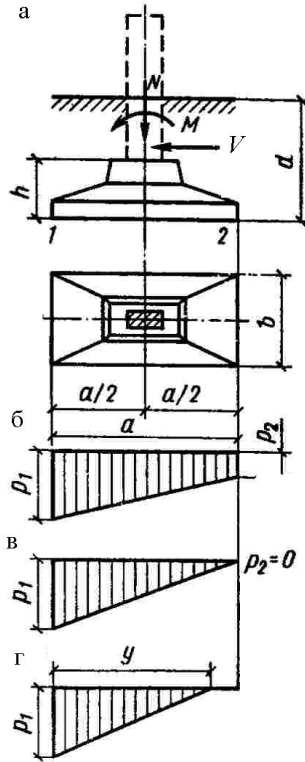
До розрахунку позациентрово-завантаженого фундаменту:
